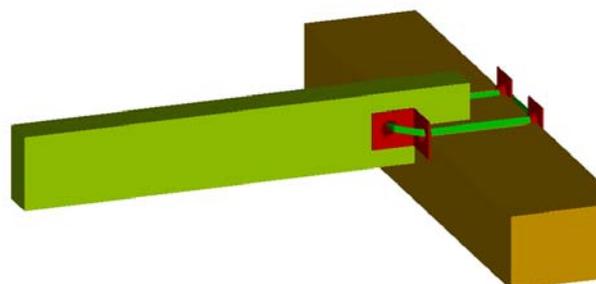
vista assonometrica del collegamento mediante CAM. La trave diventa elemento di incatenamento tra i due paramenti contrapposti
